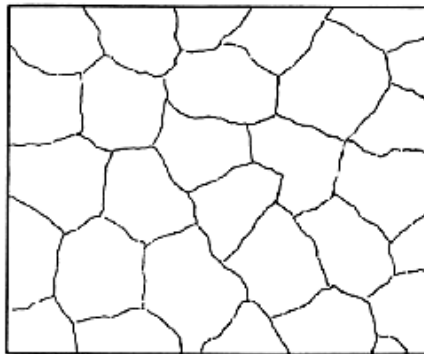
Grietas en "mapa" en un muro o losa
